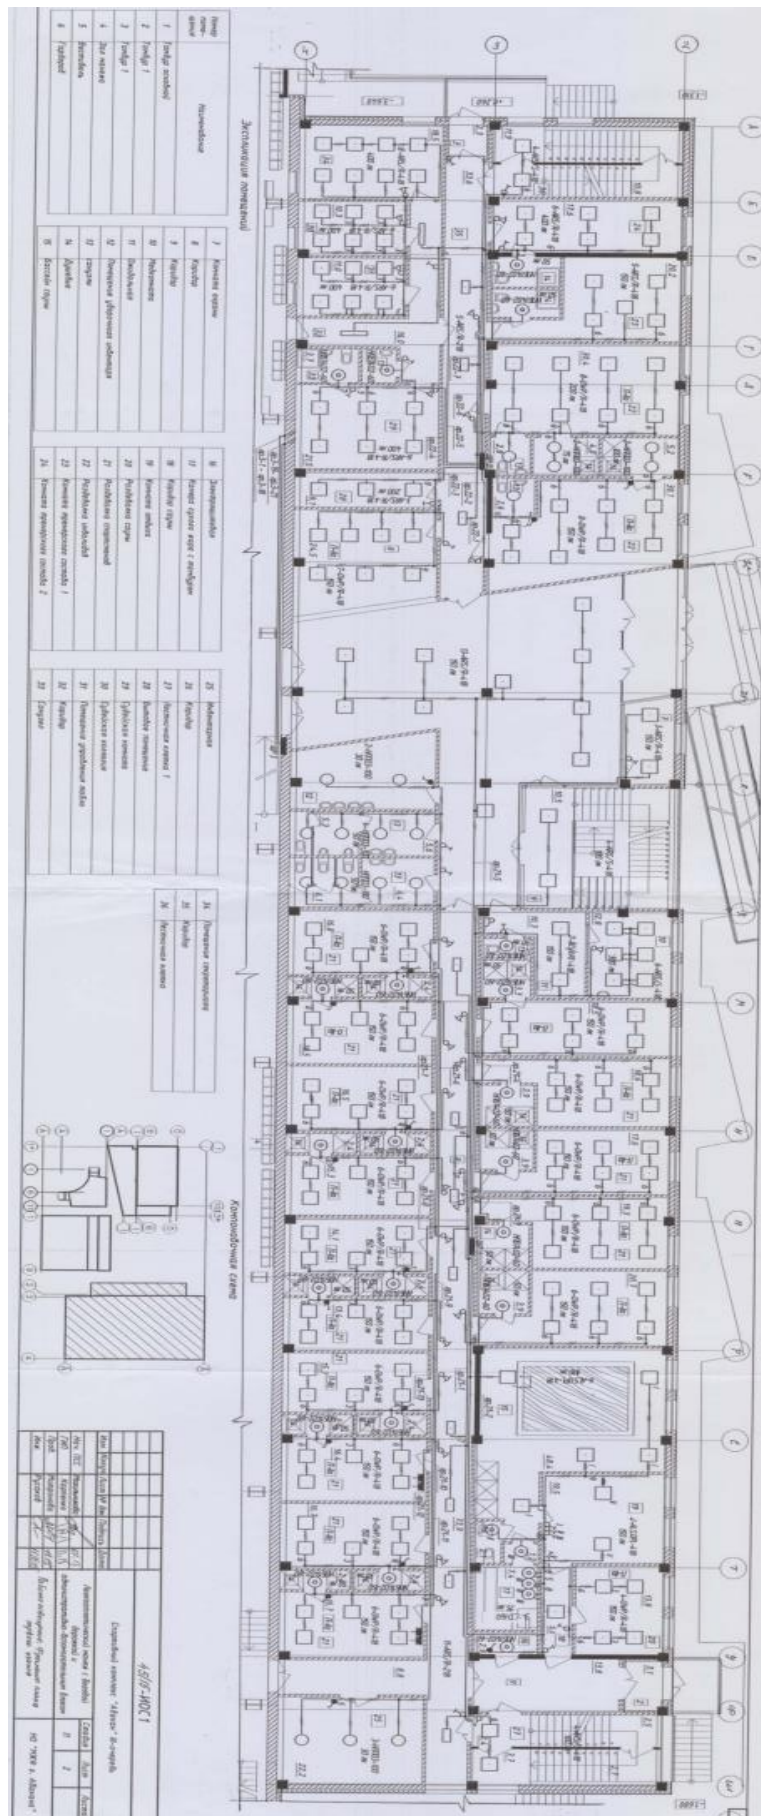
Размещение выбранных светильников на планах помещений спорткомплекса (1-й этаж)
